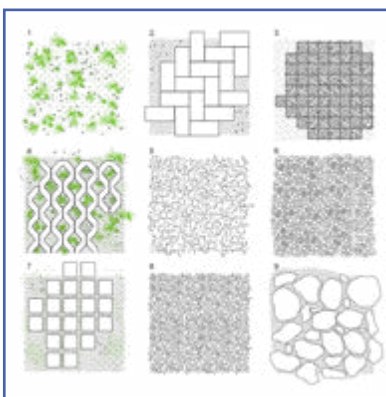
PAVIMENTAZIONI DRENANTI:
